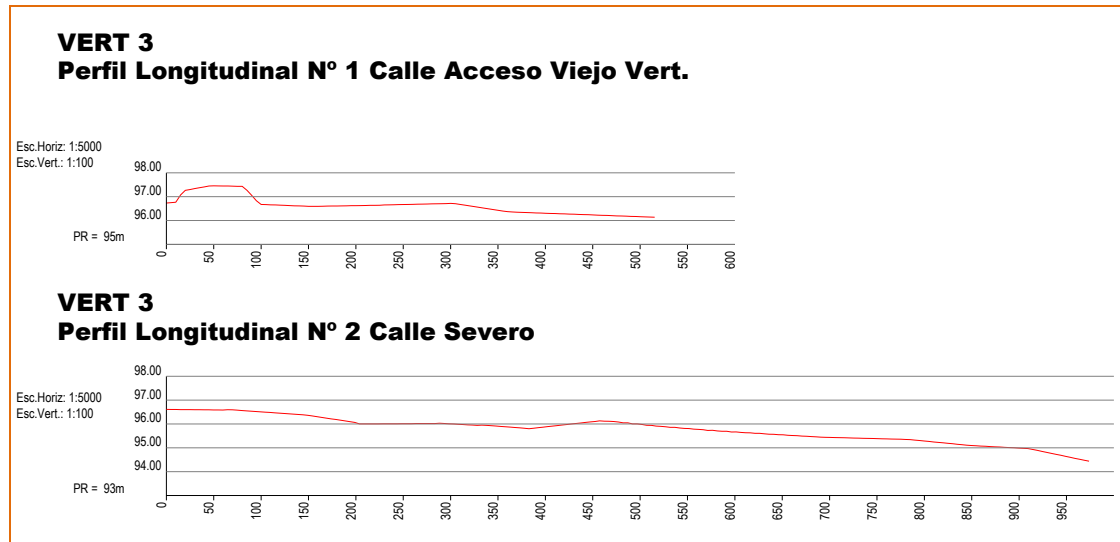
Perfiles longitudinales - VERTEDERO N°3
